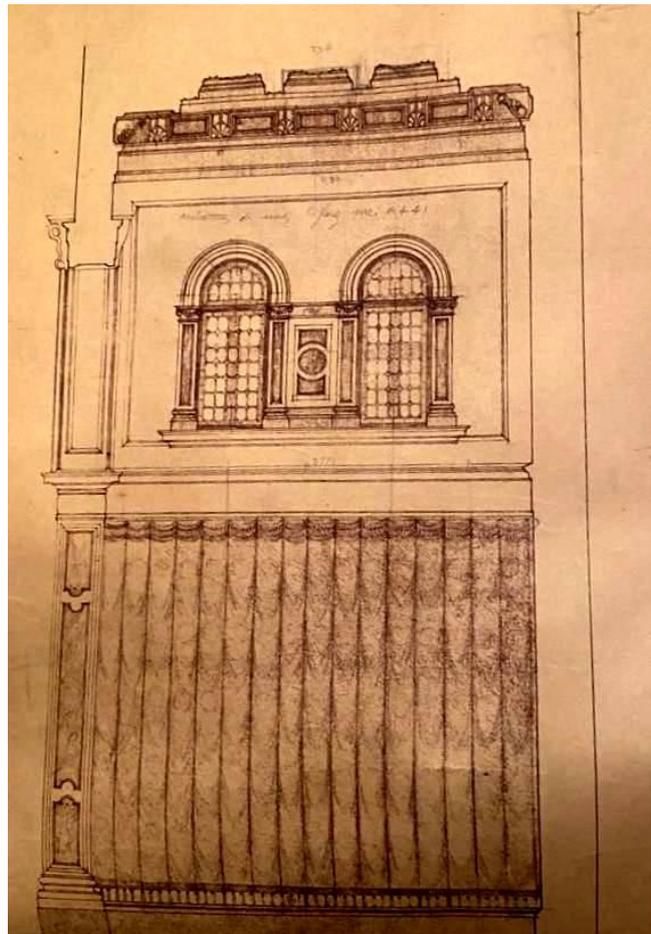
Dall'archivio Frangipane. Bozzetto di Cesare Miani per la parete laterale della cappella.
